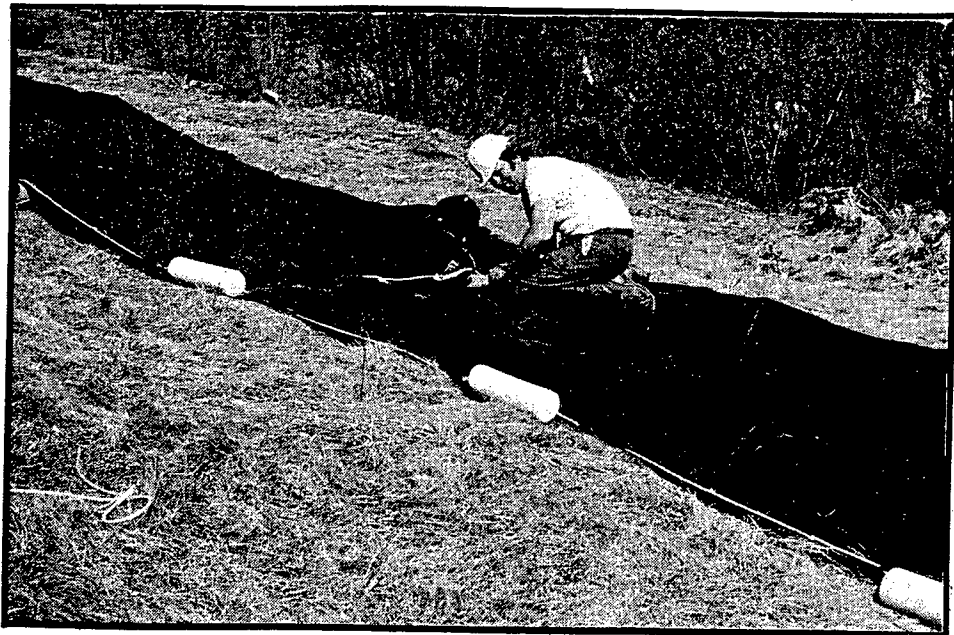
Assemblage d'une barrière à limon sur la rive du lac Vernon (flotteurs, corde de nylon, membrane de fabrène)
